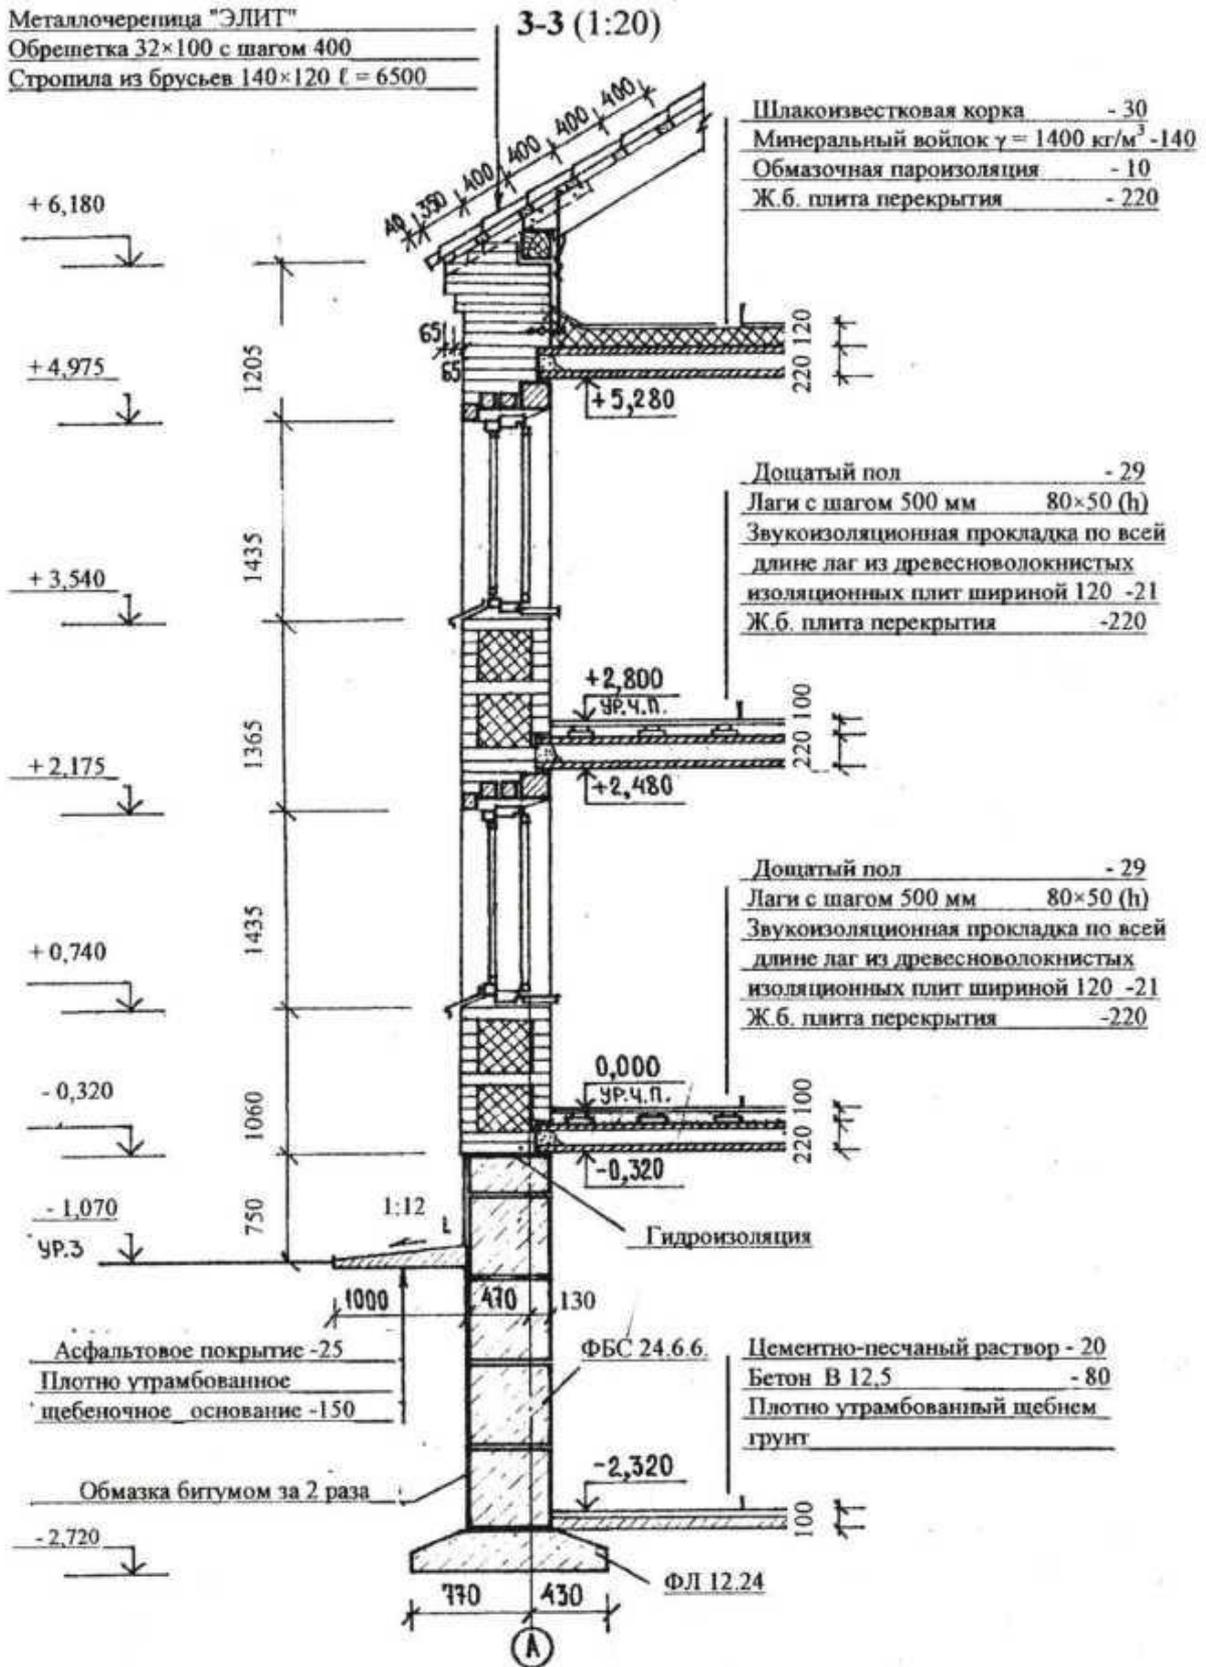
Конструктивный разрез по кирпичной стене со сборными фундаментами
